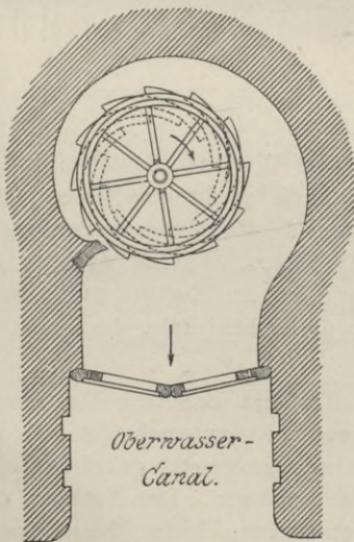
Grundriss der Kreiselpumpe.
